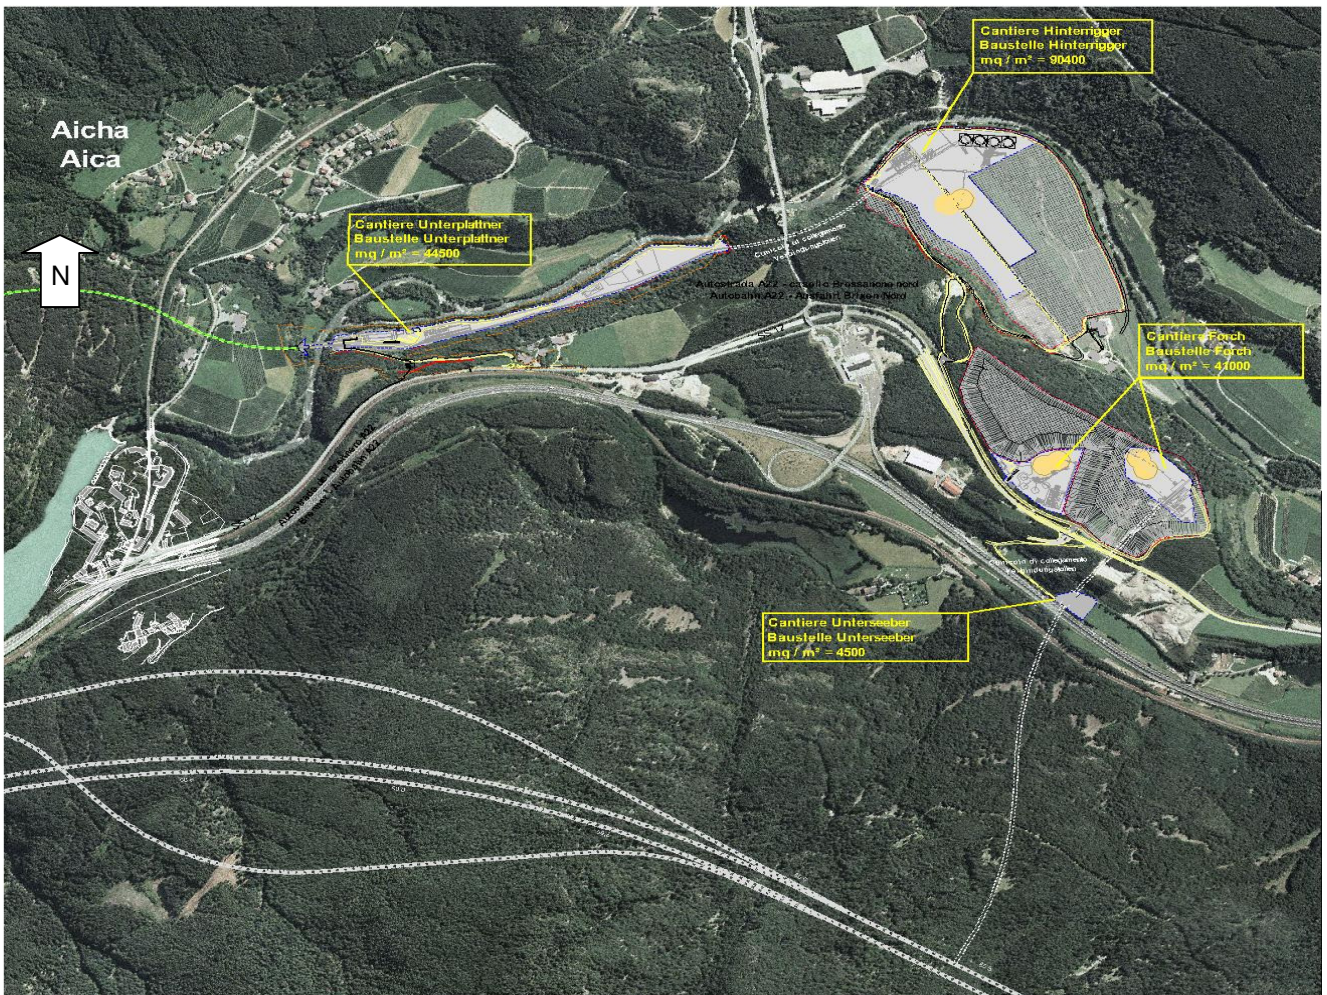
Detail des Bereiches Unterplattner – Hinterrigger - Forch
